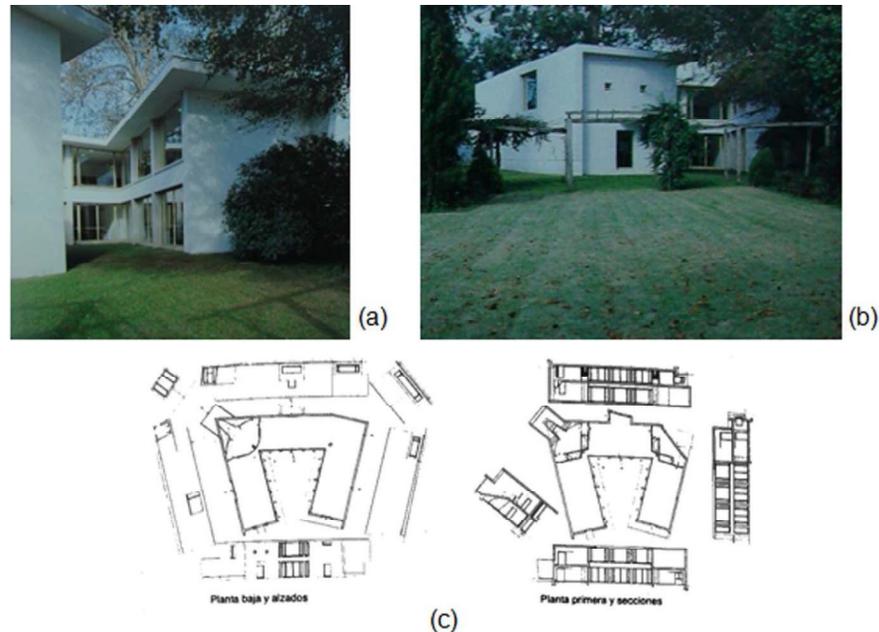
Álvaro Siza, *Ampliación de la Escuela de Arquitectura de Oporto, Portugal, (1987-1994)*. (a) Vista exterior del pabellón con el patio, (b) Vista exterior del pabellón, (c) Planta baja y alzados y Planta primera y secciones.
